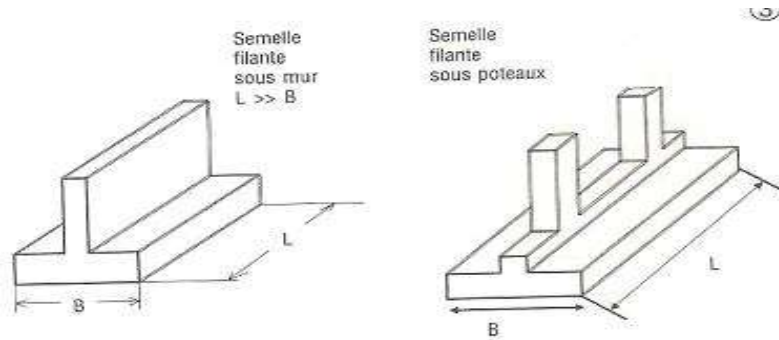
Schéma d'une semelle filante (continue) [4]
